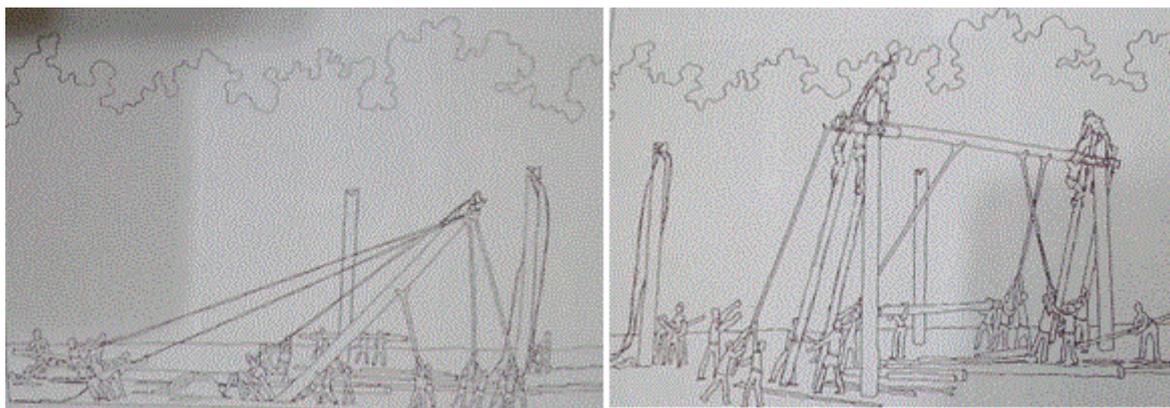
Proceso de izamiento de las columnas y amarre de viguetas.
